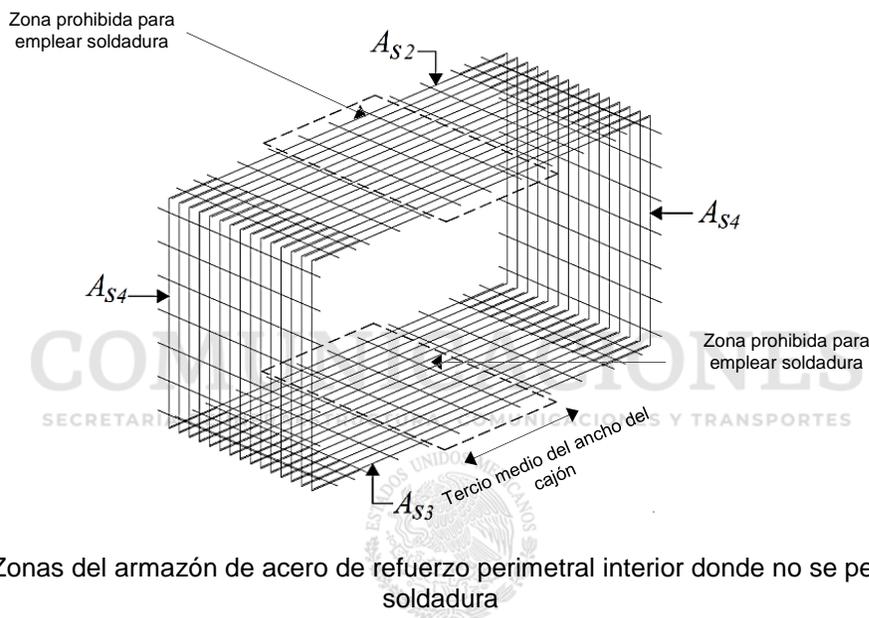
Zonas del armazón de acero de refuerzo perimetral interior donde no se permite emplear soldadura
